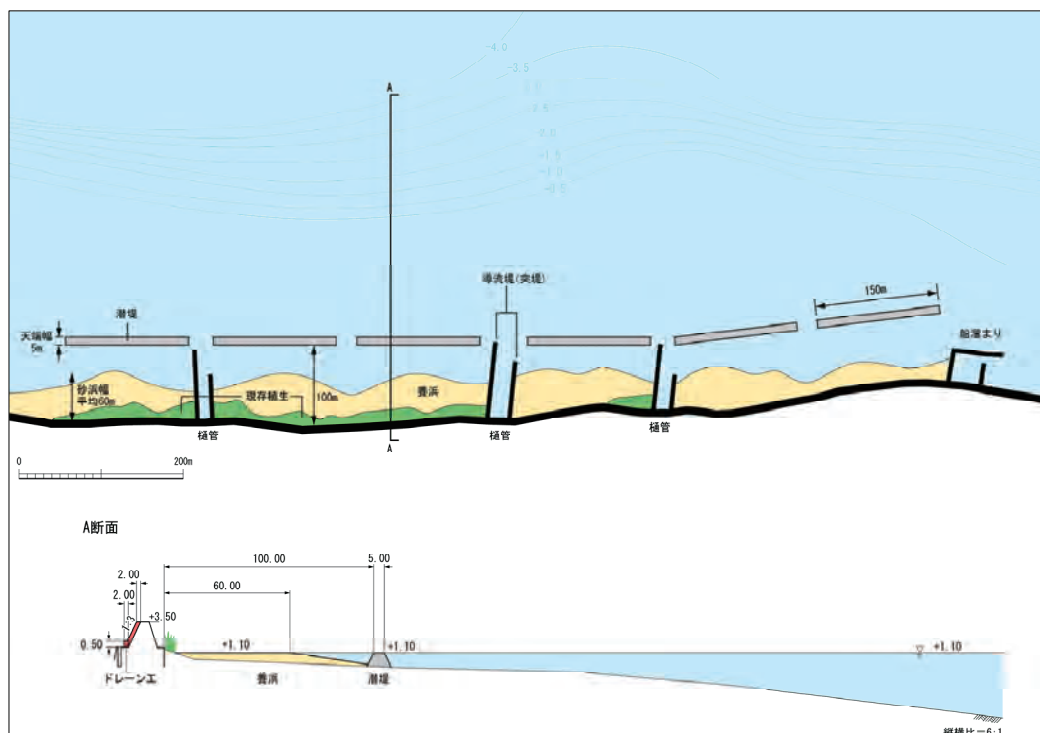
・8 B-1ゾーン 湖岸整備の平面配置および断面図案
